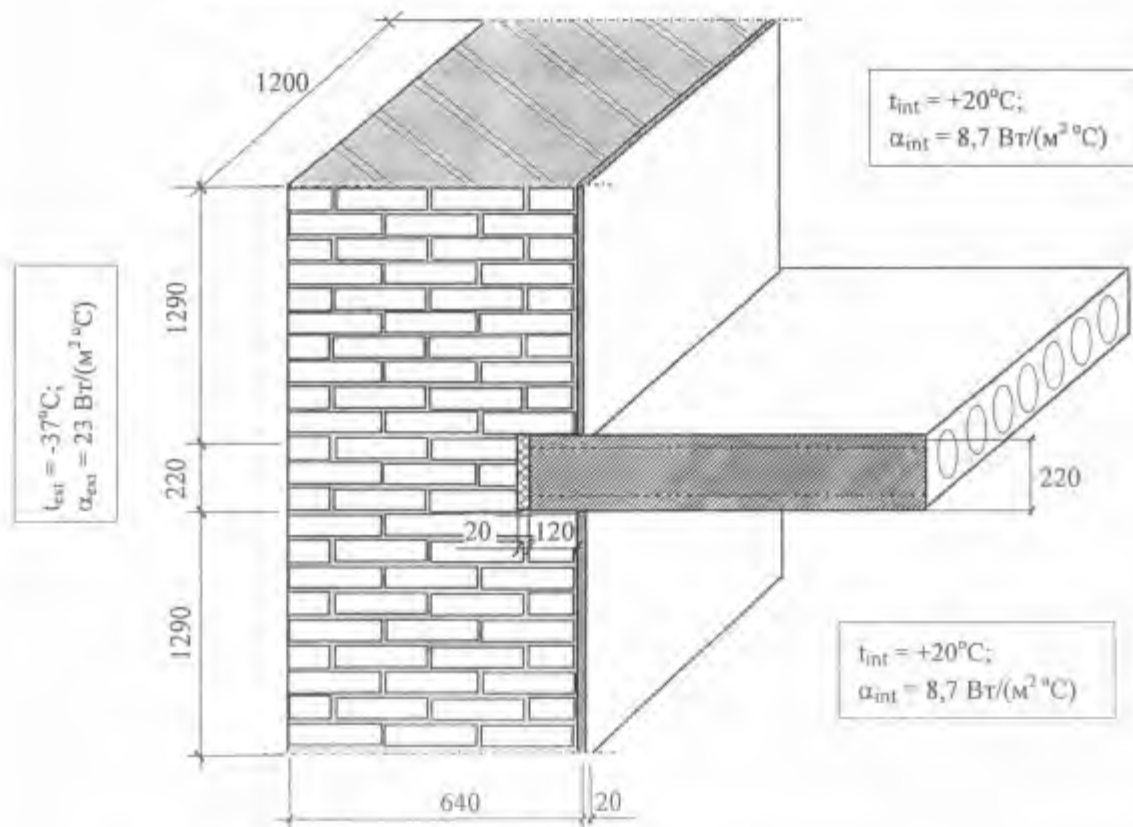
Схема задания граничных условий фрагмента наружной стены здания для определения приведенного сопротивления теплопередаче
